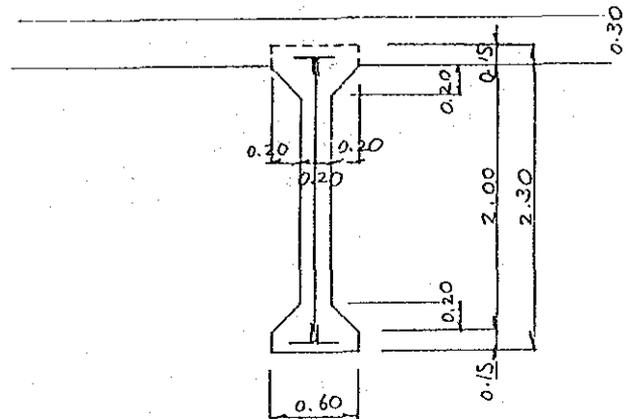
Dimensión de la Viga (Muelle No.7)
